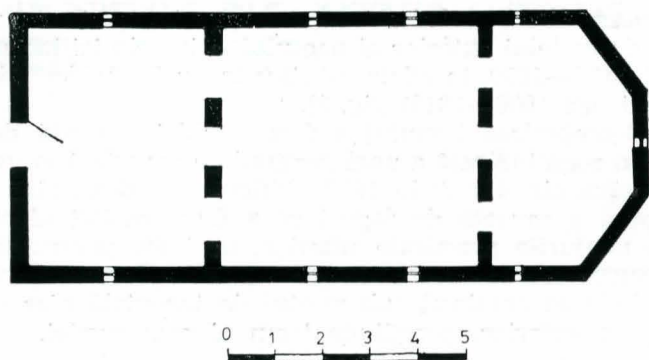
Biserica de lemn Lipia — Săpata, Plan
